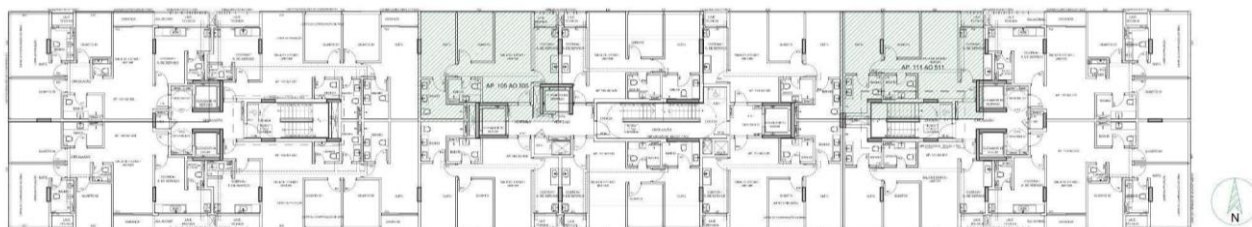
Planta baixa do apartamento 211 do edifício B.
